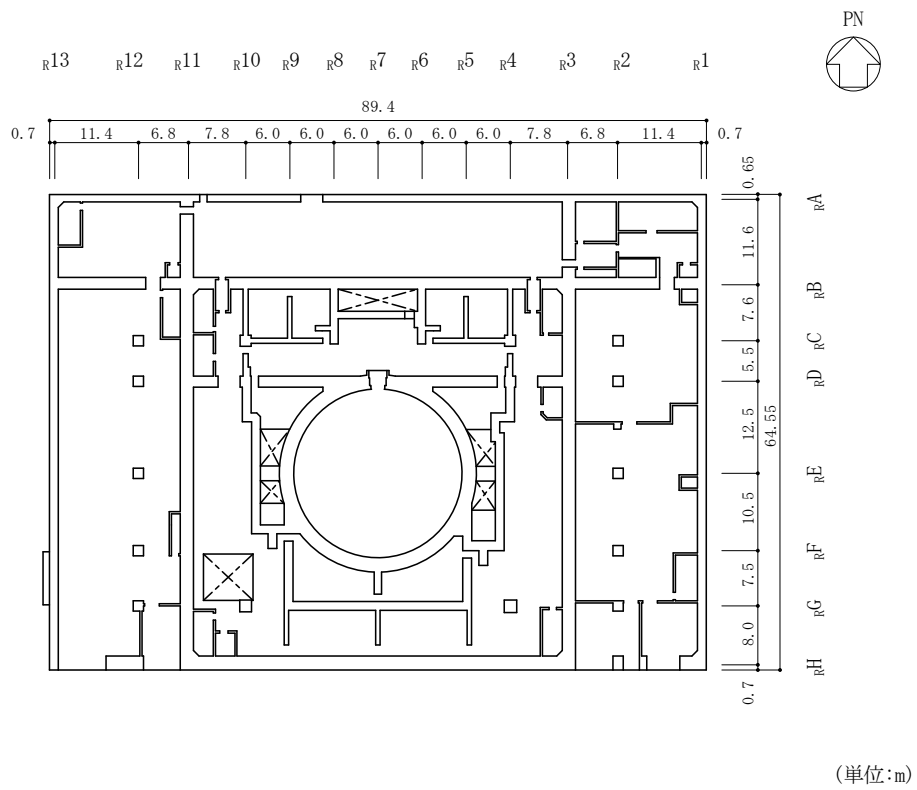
(4) 原子炉建物の概略平面図 (EL 23.8m)
